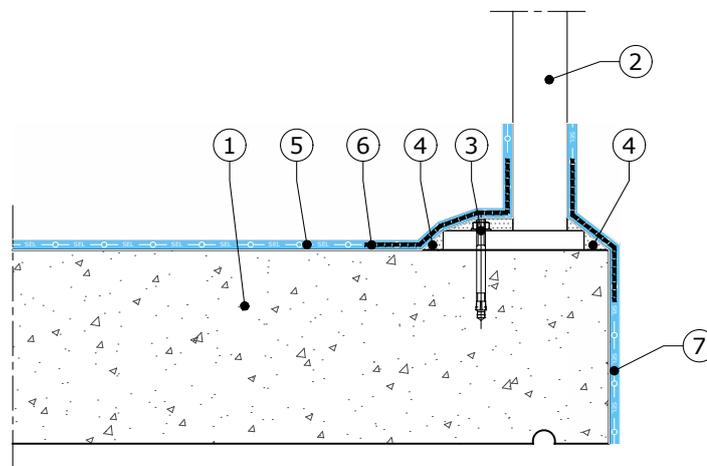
Travaux de rénovation - Garde-corps existant avec poteaux pleins - Exemple
